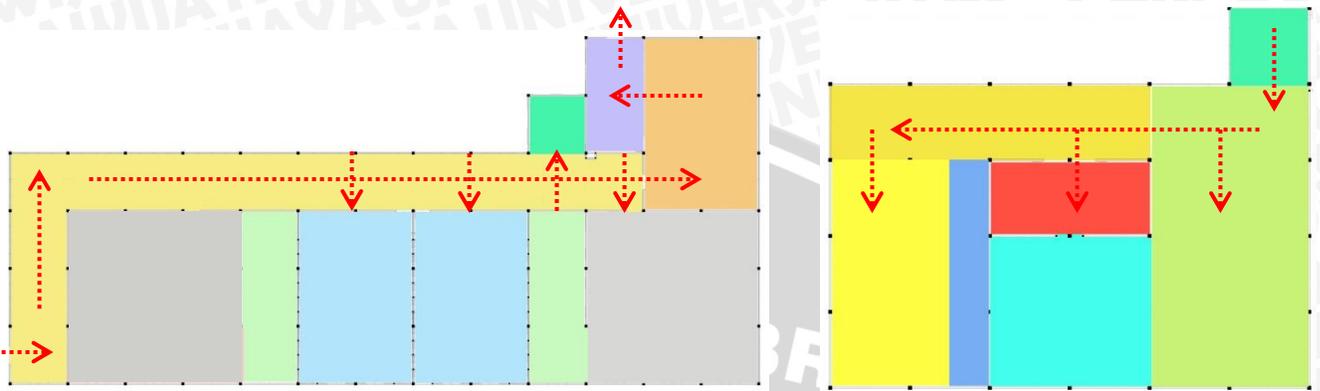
Konsep sirkulasi ruang dalam zona pengelola
